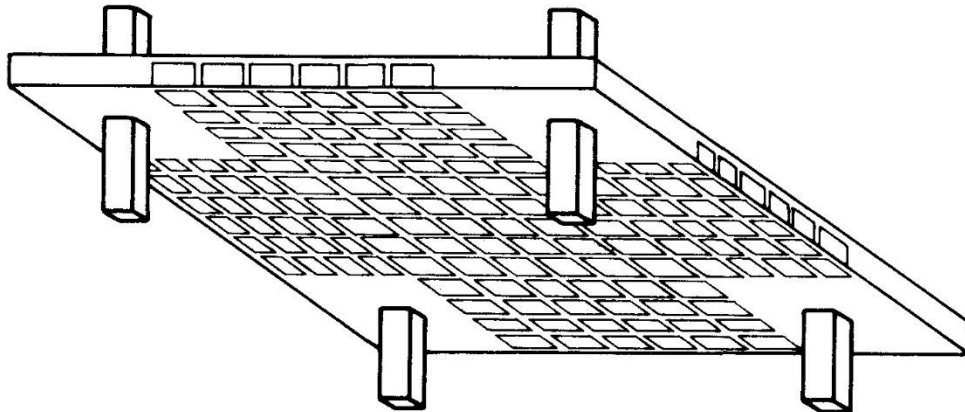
Modalidades de la losa plana de concreto reforzado. Losa plana reticular.
